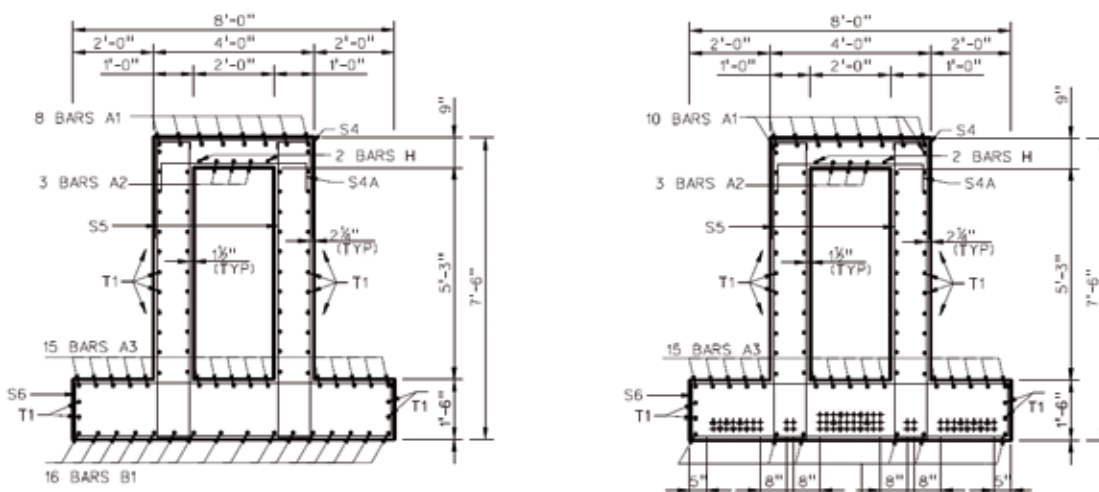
Dinteles prefabricados. Secciones transversales sin armaduras pretensas y con ellas
